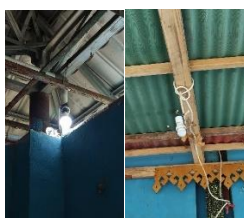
Ventilasi Pada Ruang Toilet Pertama
